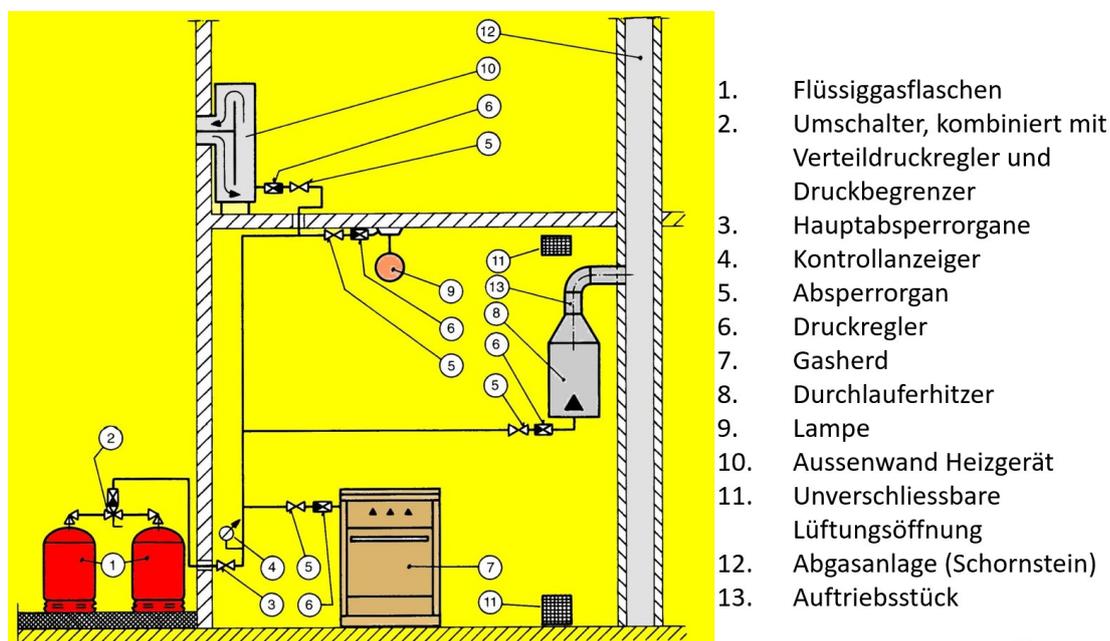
Beispiel Flüssiggasinstallationen im Haushalt (≤ 1.5 bar)
